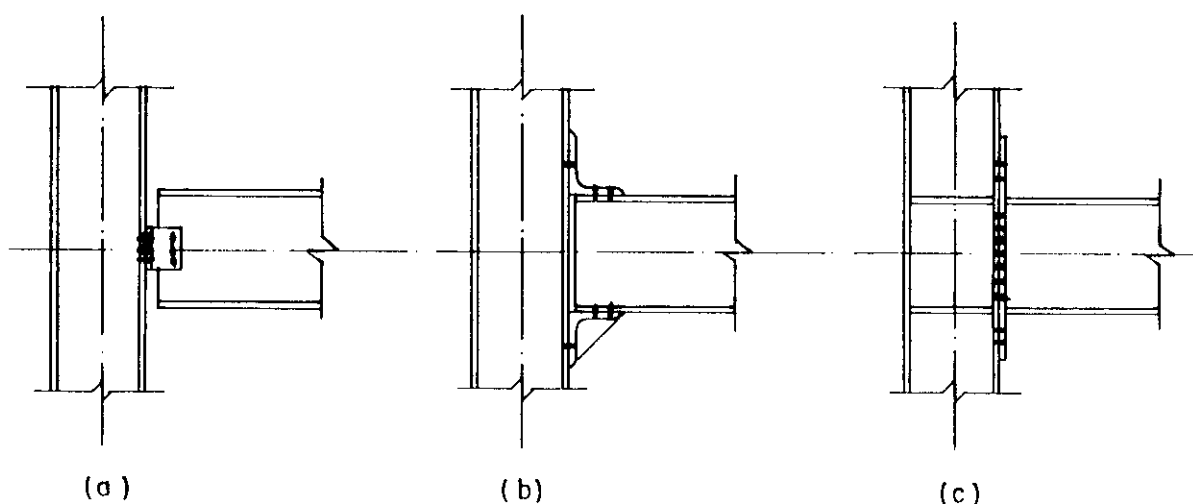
Ligações de vigas-colunas: (a) Ligação simples; (b) ligação semi-rígida e (c) ligação rígida.
